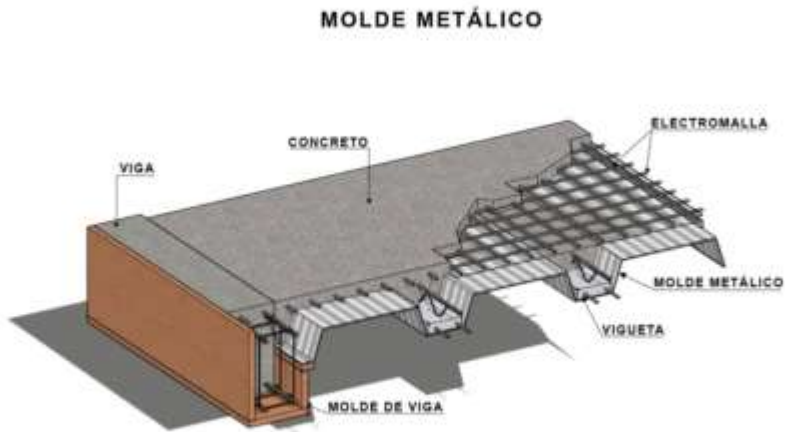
LOSA APOYADA SOBRE VIGAS EN UNA DIRECCIÓN
